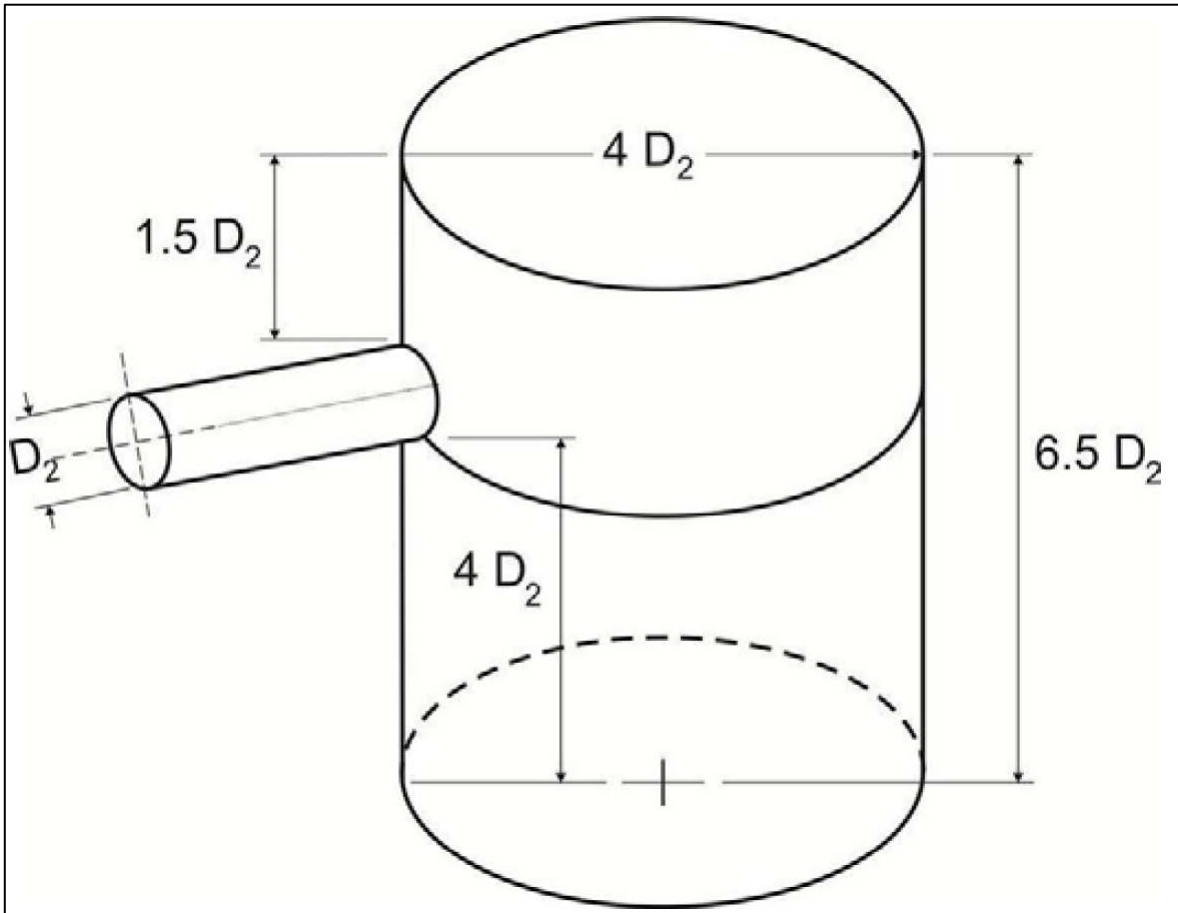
Dimensiones mínimas de la Boca de Tormenta.
